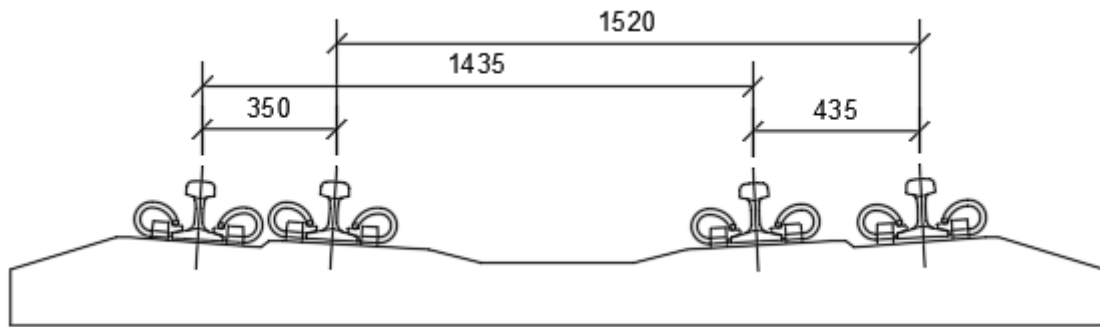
Схематичне зображення поперечного перерізу суміщеної колії на залізобетонних шпалах, скріплення КПП-5
